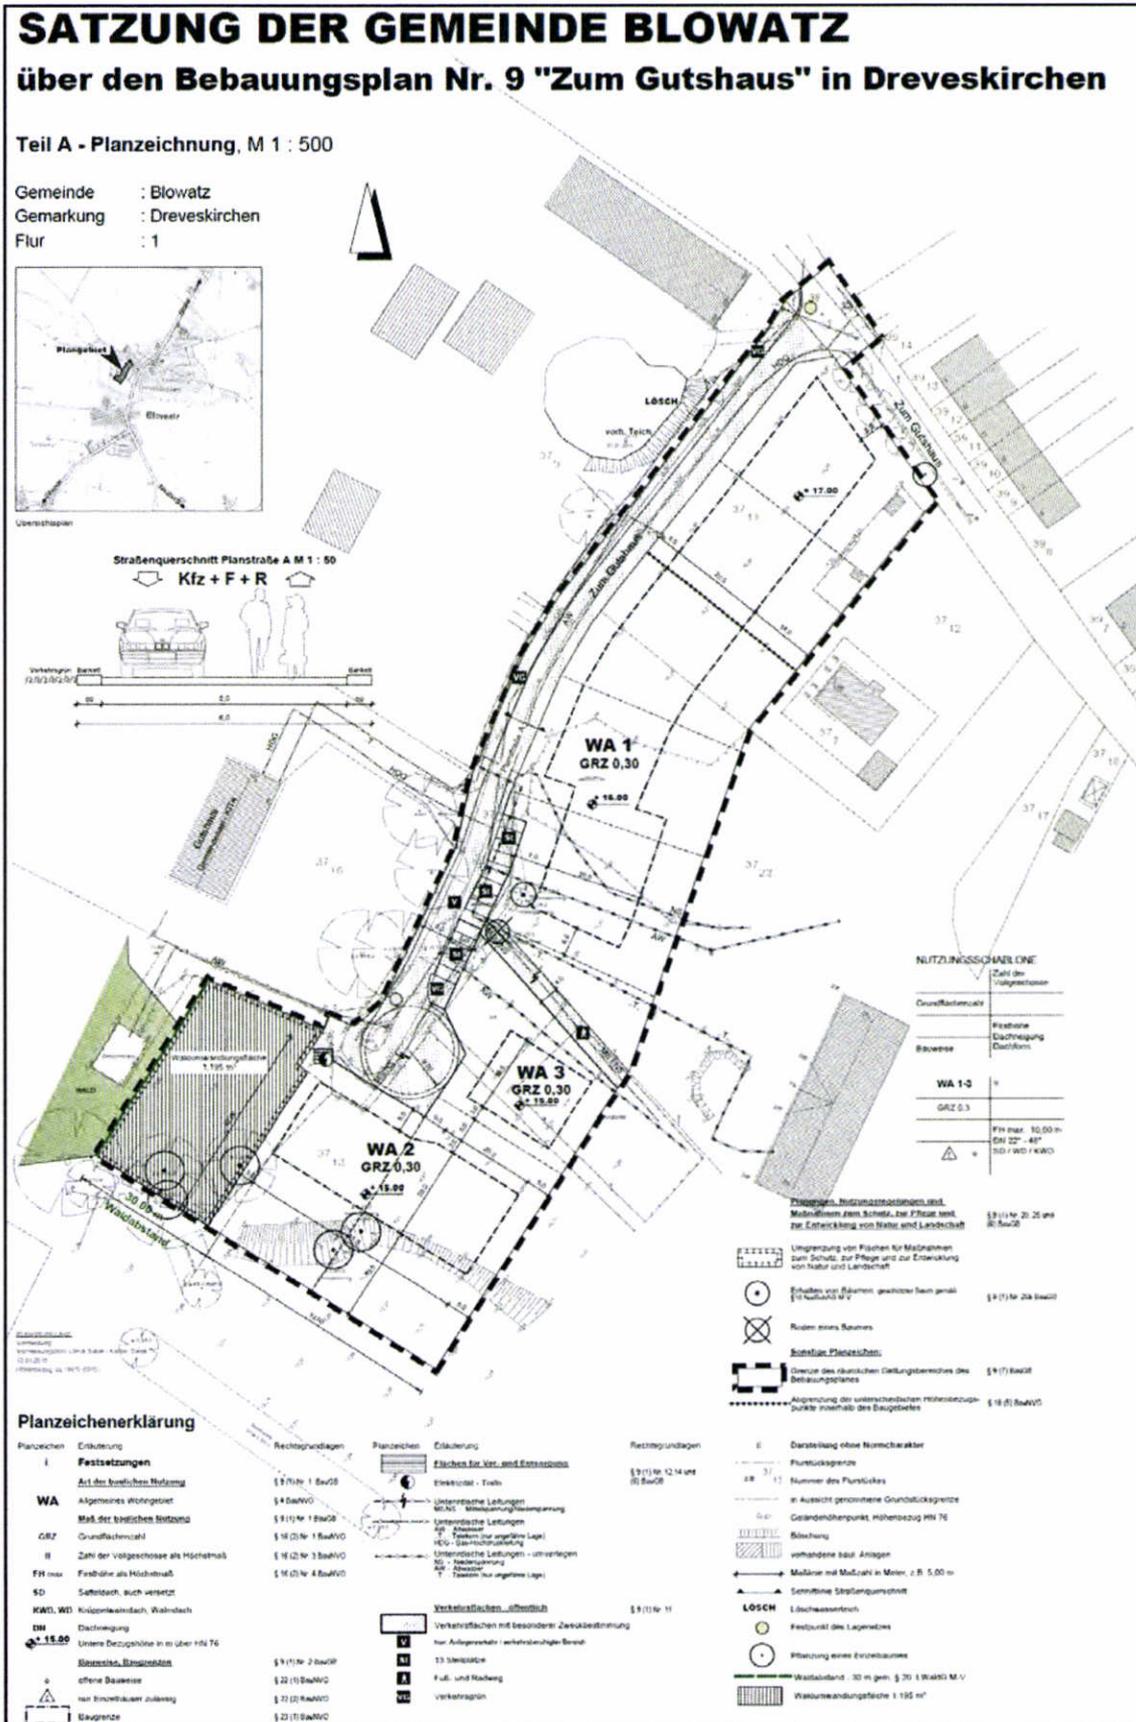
Ausschnitt Bebauungsplan, Darstellung des Plangebietes. Quelle: BAB Wismar Februar 2018.
